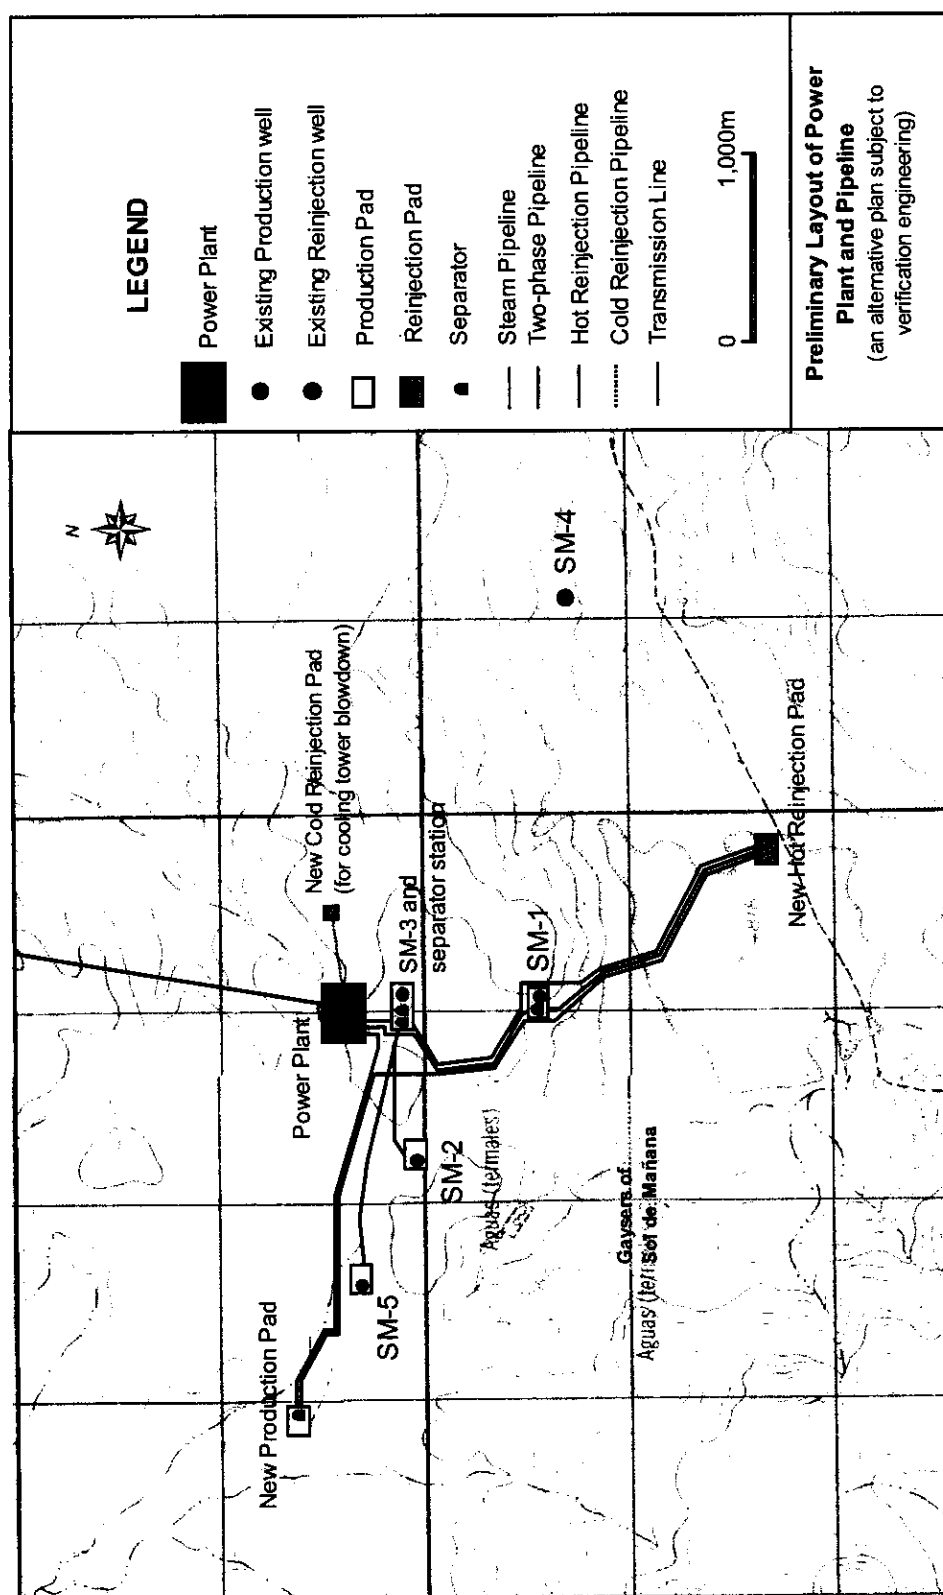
発電所およびパイプライン配置図（計画変更後）
